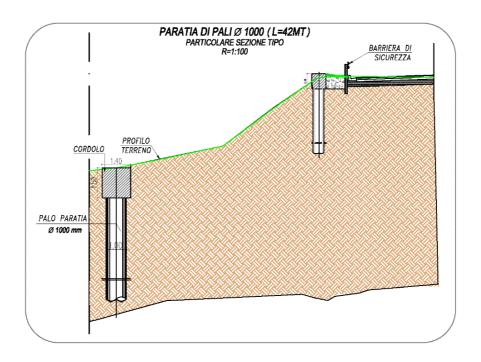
Sezione trasversale Paratia di Pali tratto sez. 56-69
